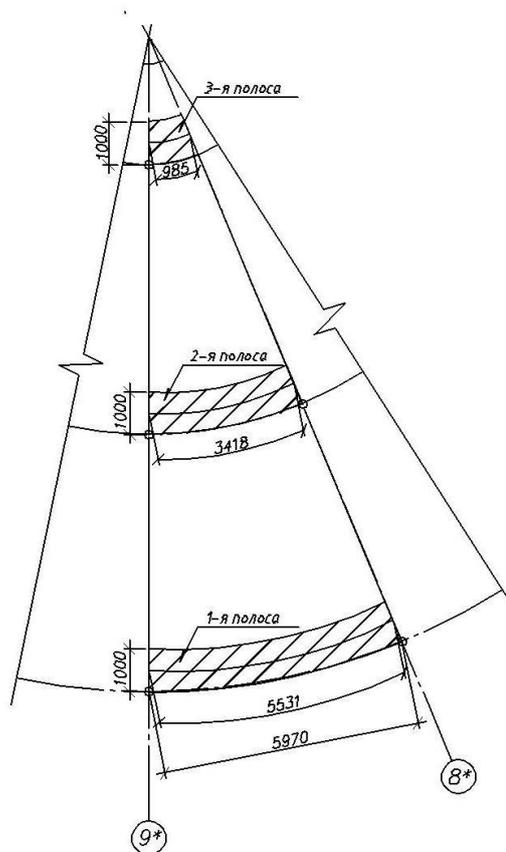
Схема расположения условных расчетных полос перекрытия
